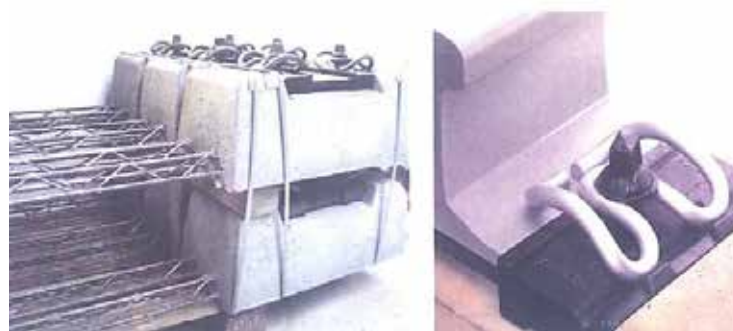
Züblin tipi üstyapı (kesit görünüşü)
